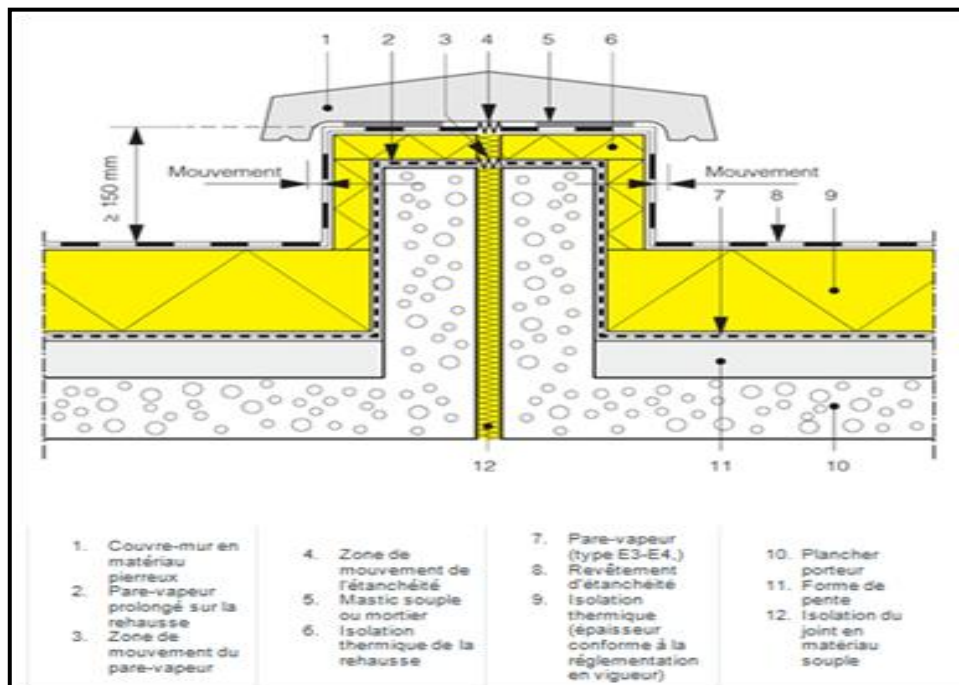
Etanchéité d'un joint de mouvement réalisée au moyen d'un couvre-mur en matériau pierreux.
